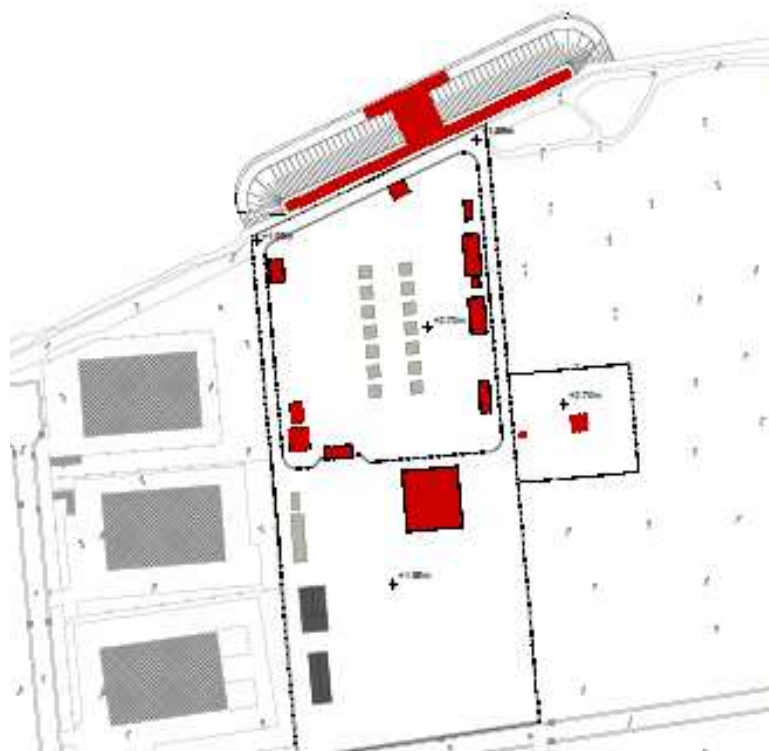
Fase 4 completamento sovrastruttura banchina e fondazioni strutture prefabbricati
